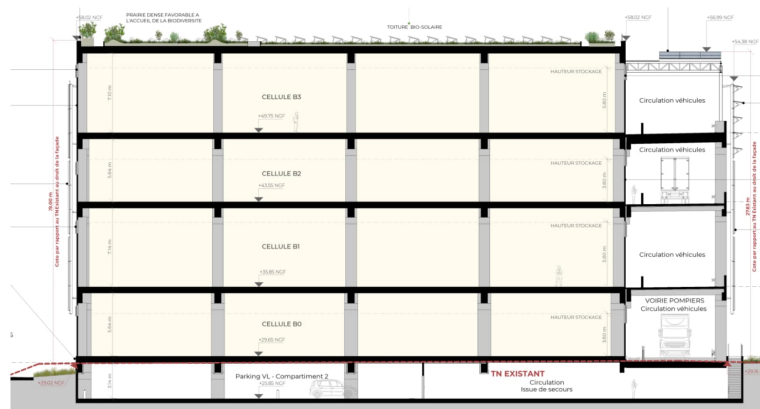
Implantation des ouvrants sur une coupe transversale aux cellules B0 à B3
